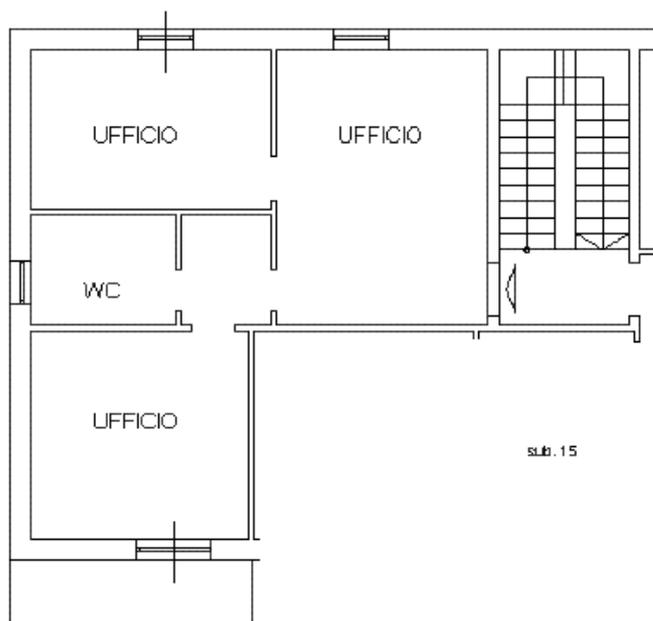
STRALCIO PLANIMETRICO DELL’U.I.U. OGGETTO DI ANALISI (FONTE: INTERNA).
